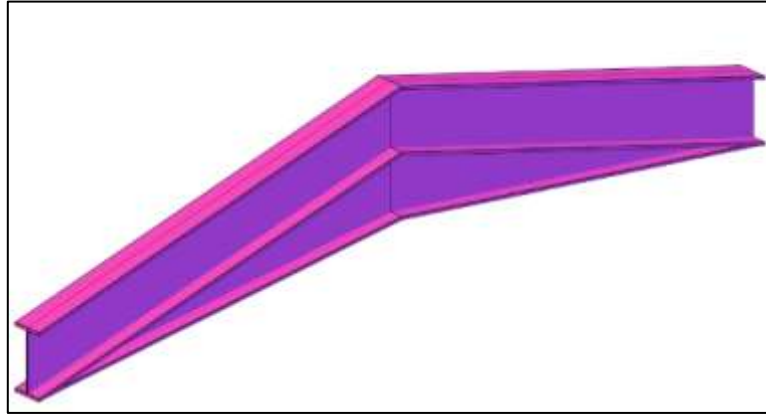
Conexión a momento Viga – Viga (Perfiles: alma llena)
